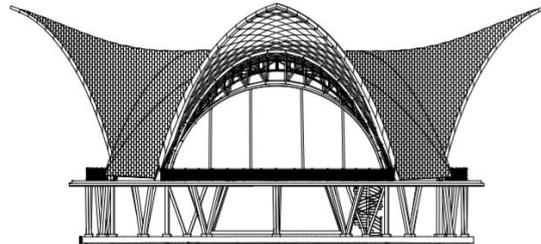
Tampak Samping Kiri dan Kanan Gedung B
